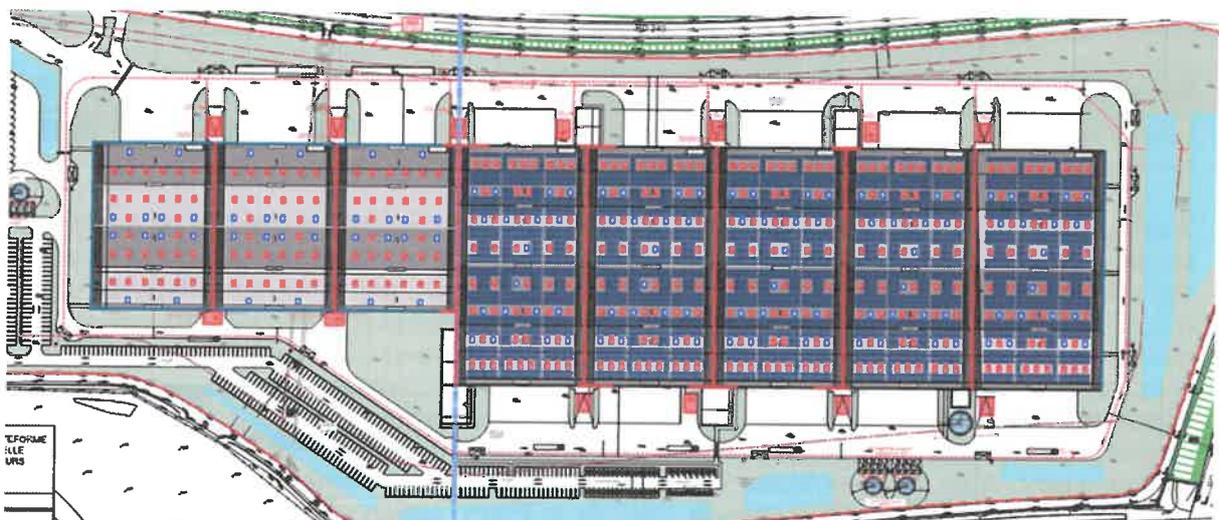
Extrait du plan masse du futur bâtiment et des aménagements connexes
